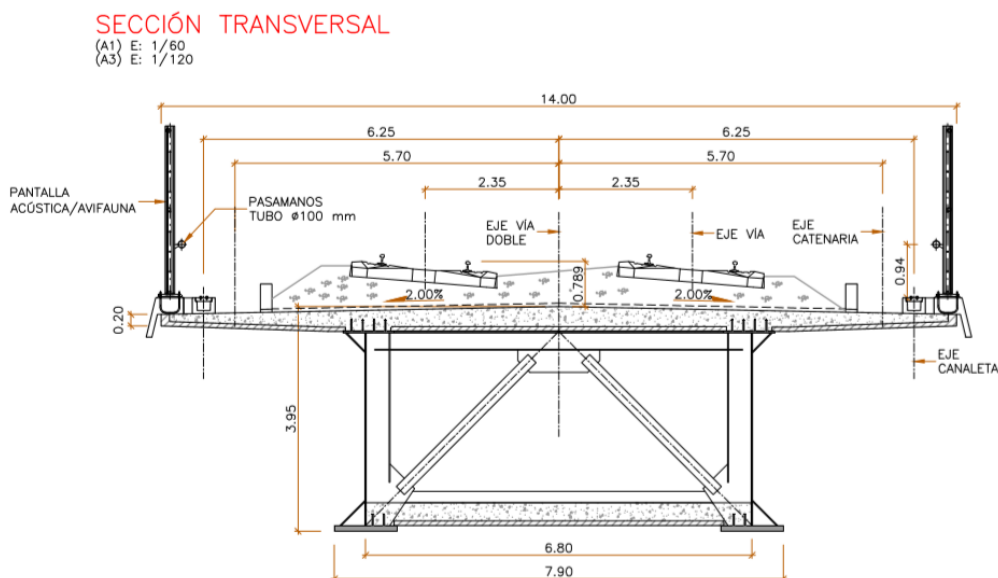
Sección transversal del viaducto. Fuente: Proyecto de construcción de plataforma del corredor mediterráneo de Alta Velocidad Murcia – Almería.
